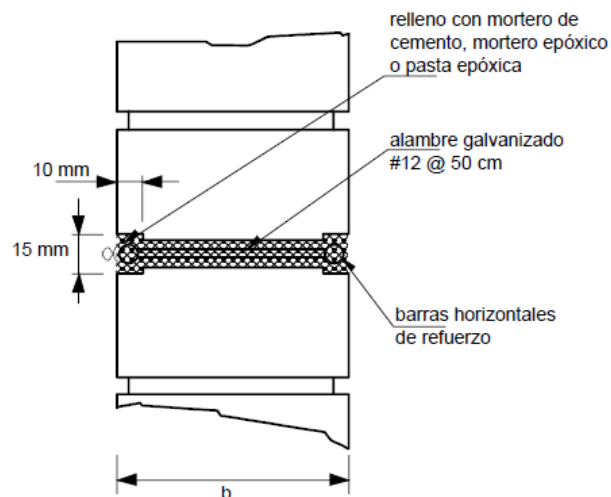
Inserción de barras de refuerzo en las juntas de un muro (Alcocer, 2003).
